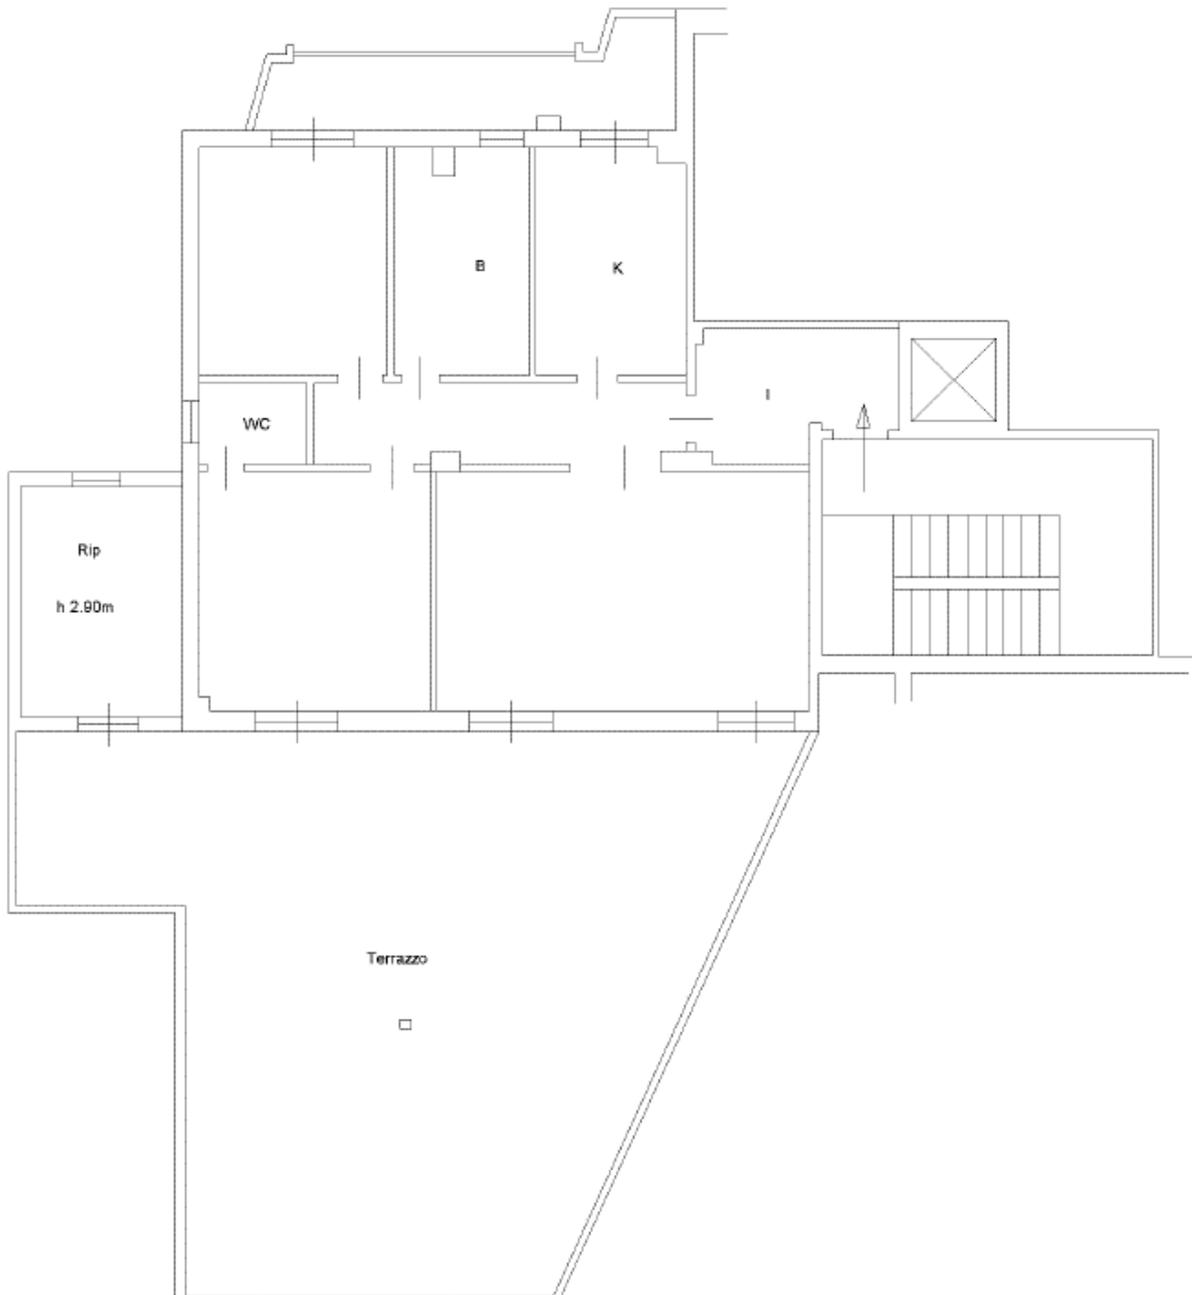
Planimetria catastale subalterno 126 (interno 1) – piano primo scala B - particella 329 – foglio 64 – Catanzaro
